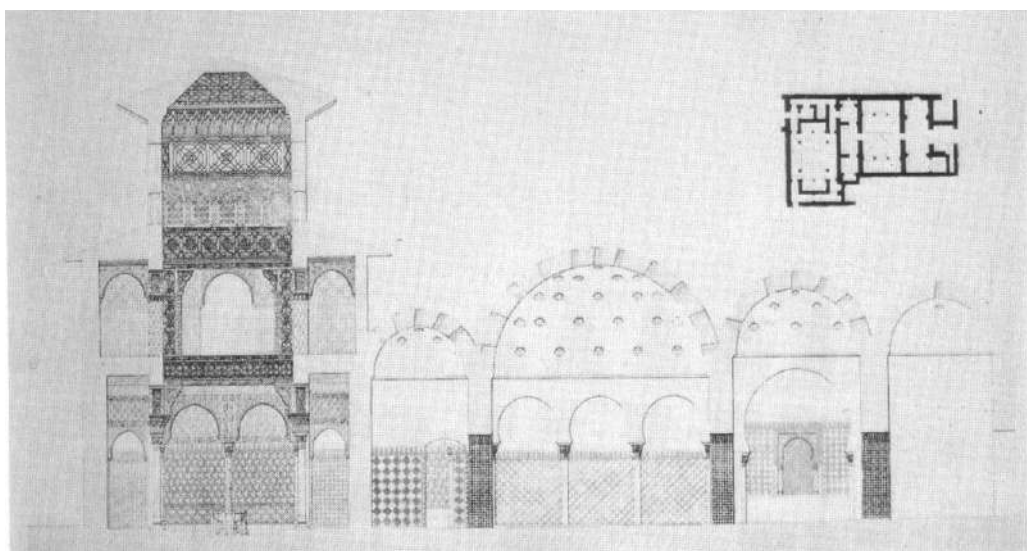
Sección y planta de los Baños de Comares, en su estado original. (*La Alhambra*).
